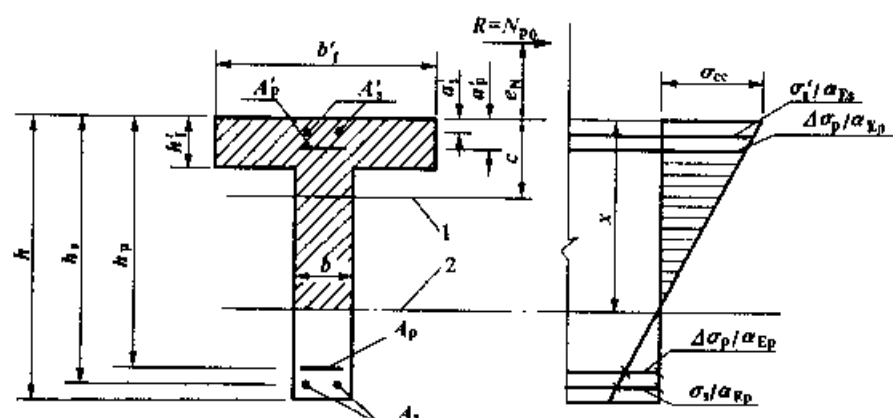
开裂后的部分预应力混凝土受弯构件截面应力计算图式
